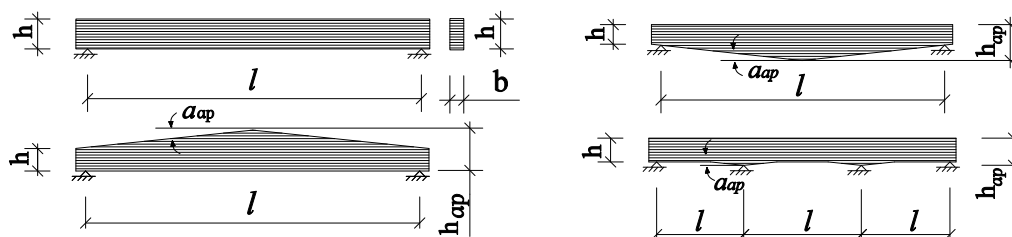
Схемы балок из слоистой клееной древесины
